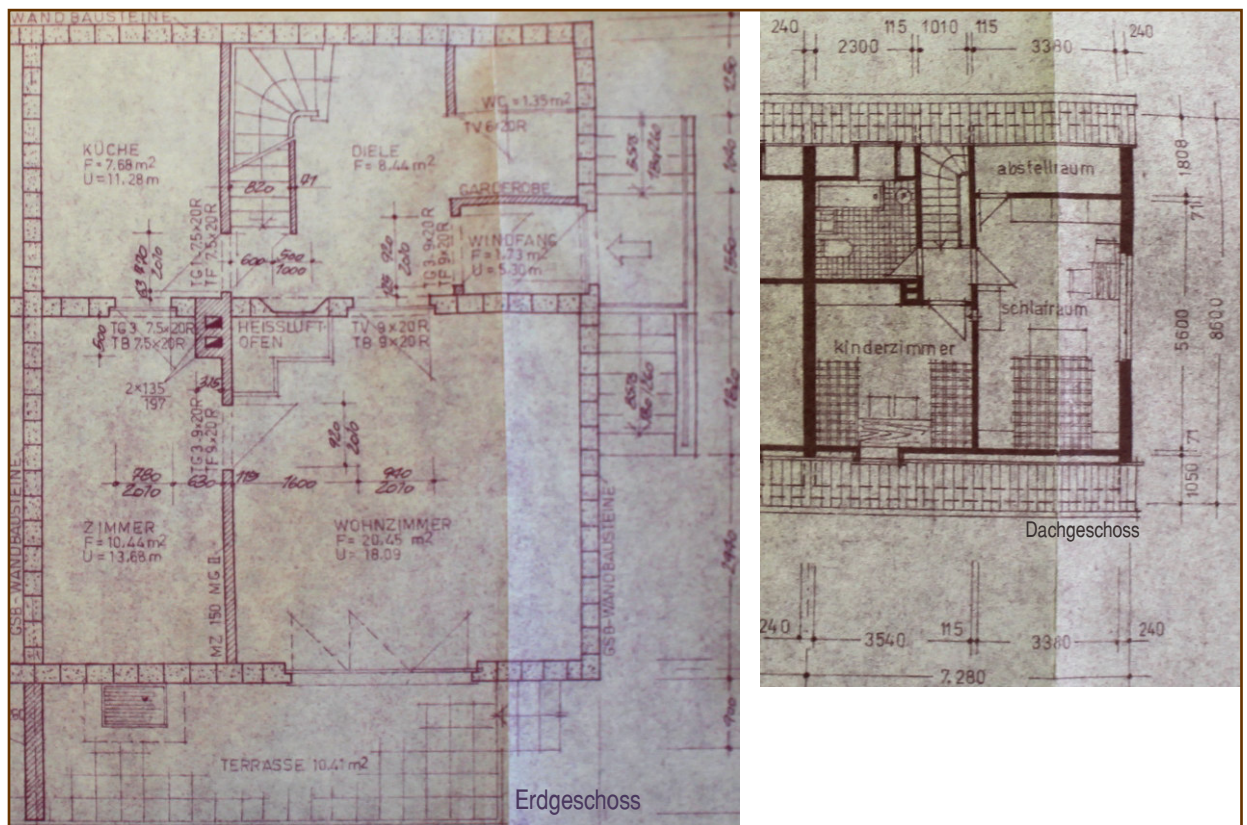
Abb. L Doppelhaus Typenhaus D 4S/72-GSB, Grundrissdarstellung EG und DG
